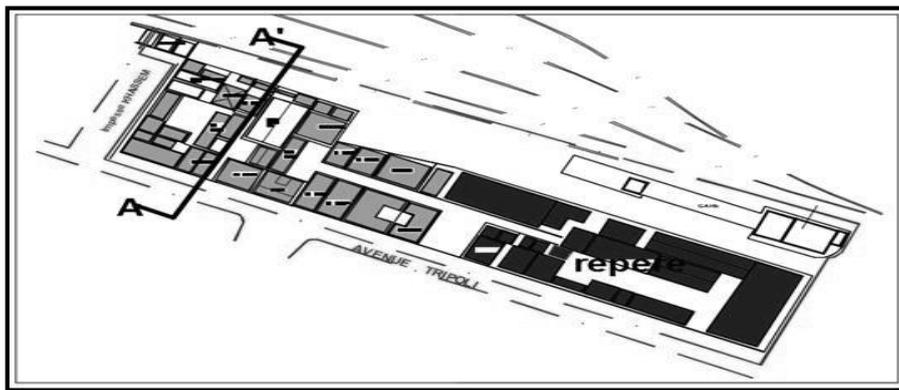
Plan d'un fragment de notre aire d'intervention.
